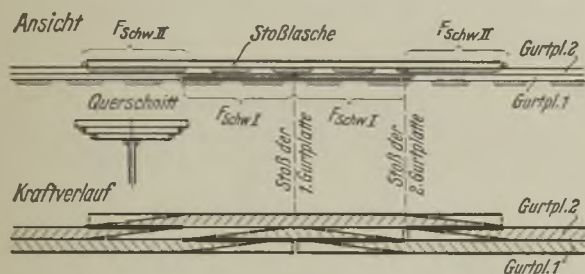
Zum Teil mittelbare Stoßdeckung mehrerer Gurtplatten mit einer Stoßlasche.
